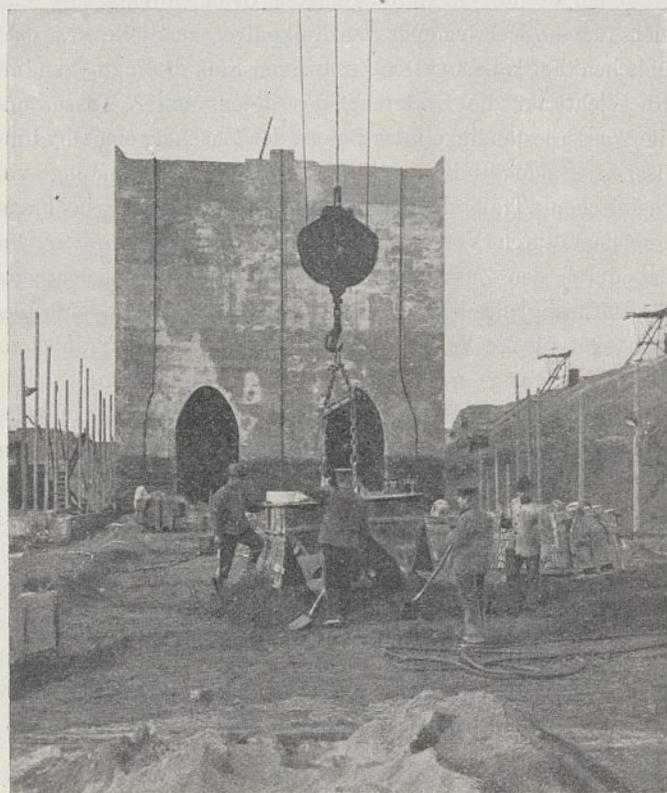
Entleeren des Betonkübels in der Baugrube.
